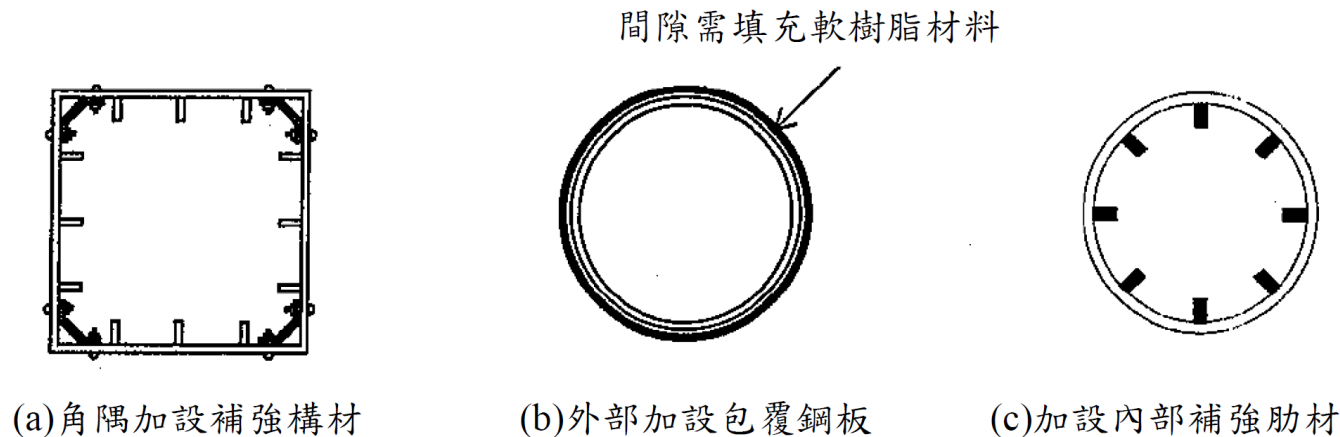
鋼橋柱加設構材補強方法示意圖
